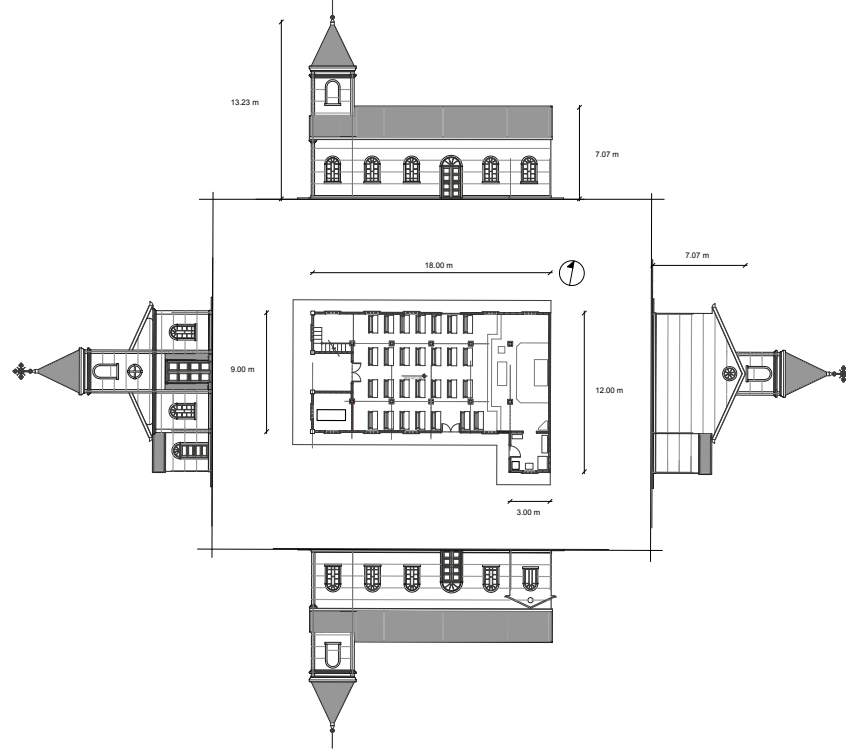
LEVANTAMIENTO ARQUITECTÓNICO IGLESIA ROSARIO. Fuente: Autor
